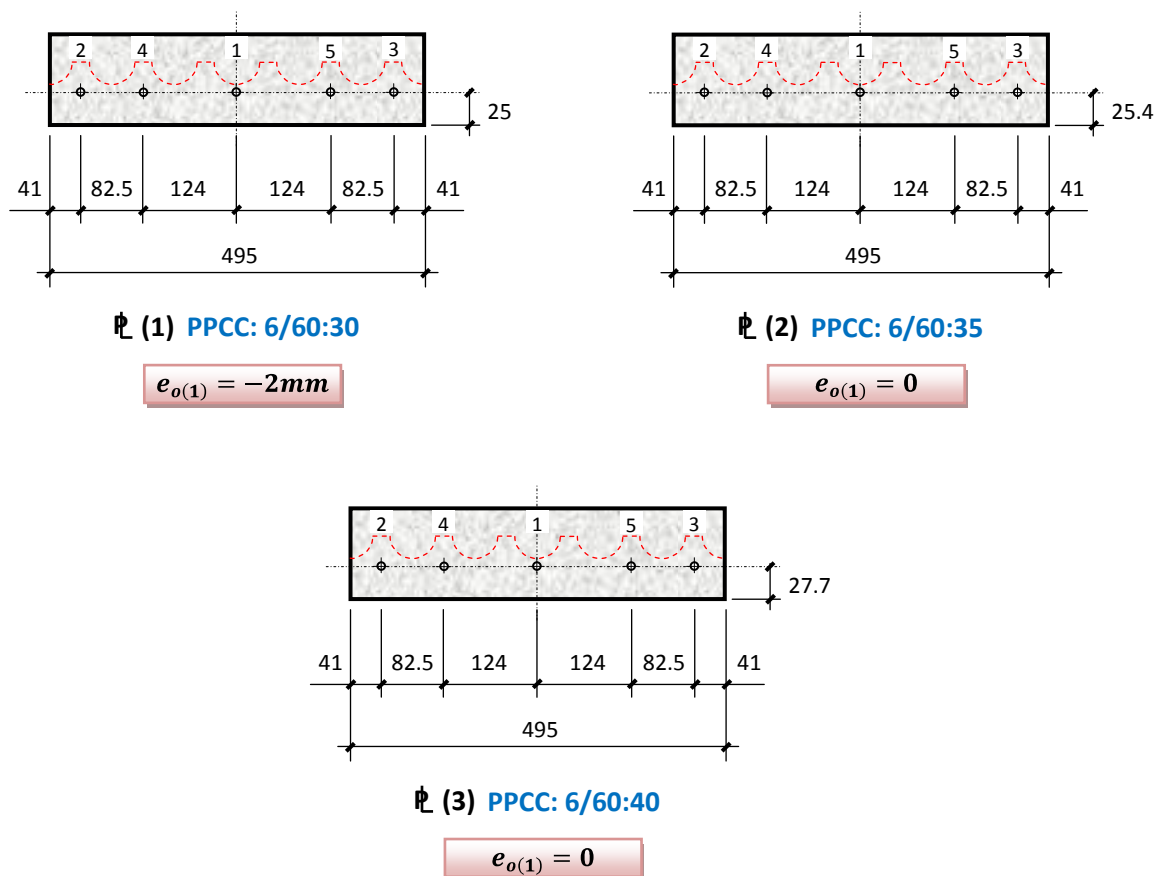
Diseño de la Plancha-Cabezal para las tres tipologías de sección de la prelosa
